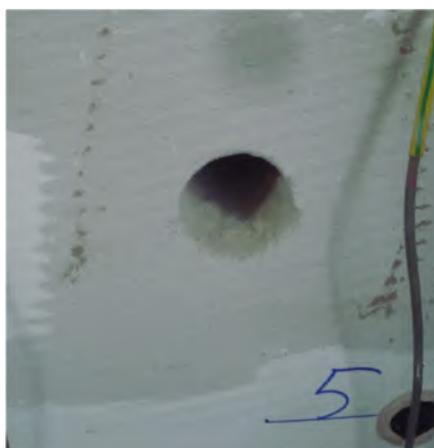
Внешний вид образца с отбором проб из фрагмента стеновой конструкции [6]
